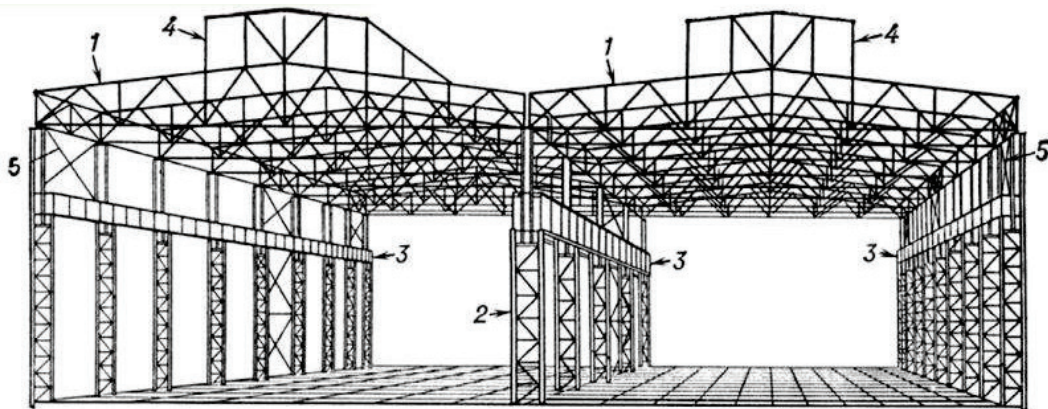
Конструктивная схема одноэтажного двухпролетного промышленного здания с металлическим каркасом:
